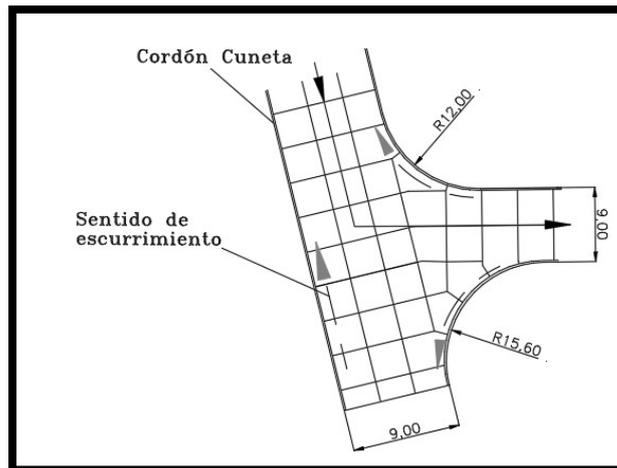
Detalle intersección Calle Acceso y Calle N° 8.
